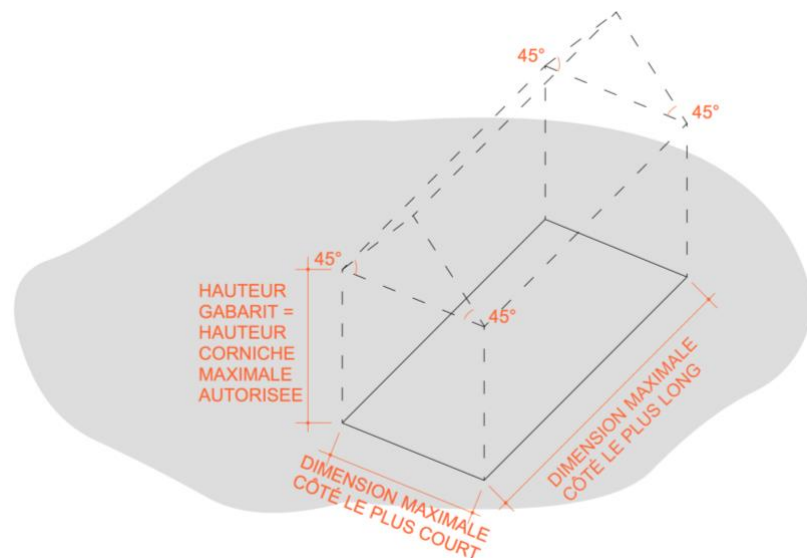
Gabarit maximal de construction - zones HAB-, MIX-, REC-, GARE ET JAR
